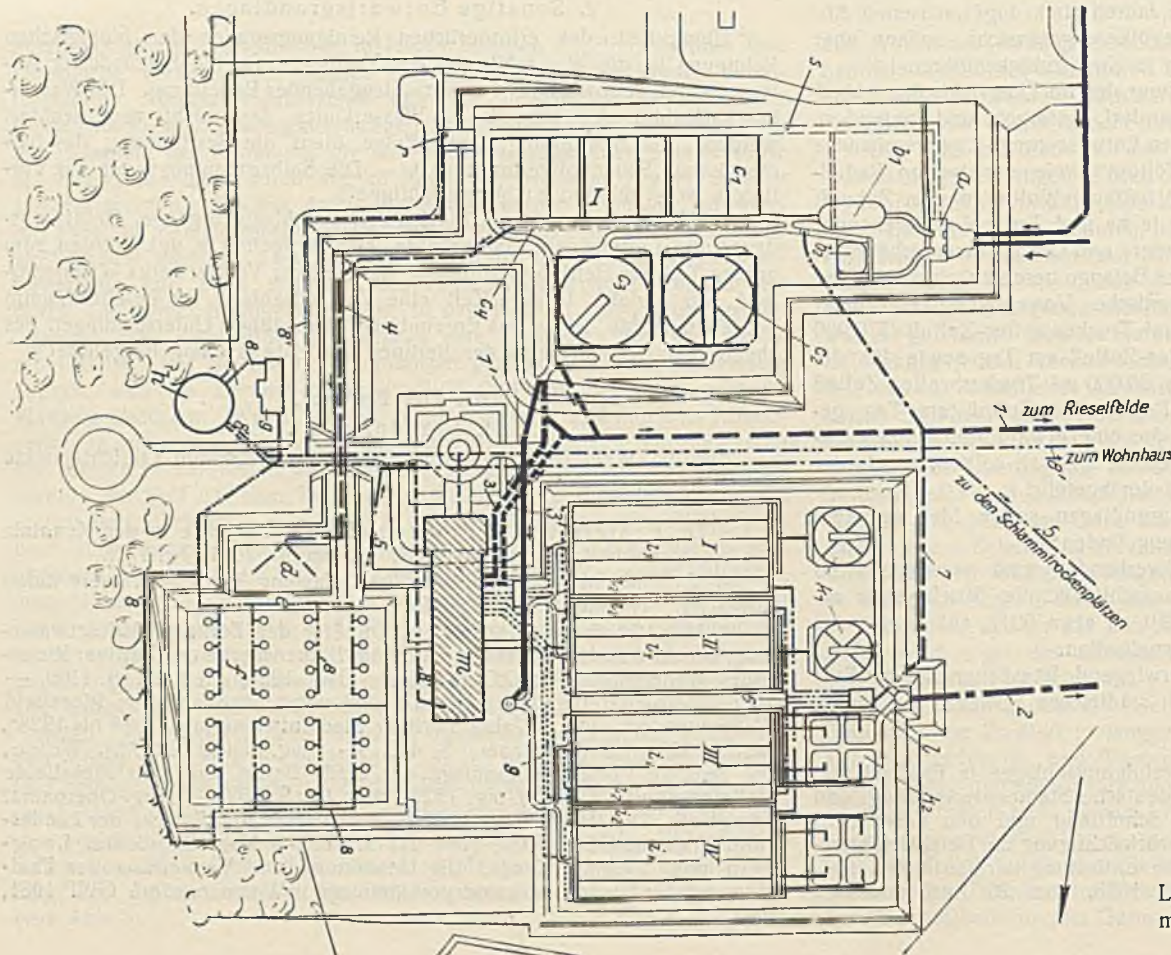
Gesamtübersichtsplan des Groß-Klärwerks Stahnsdorf.
